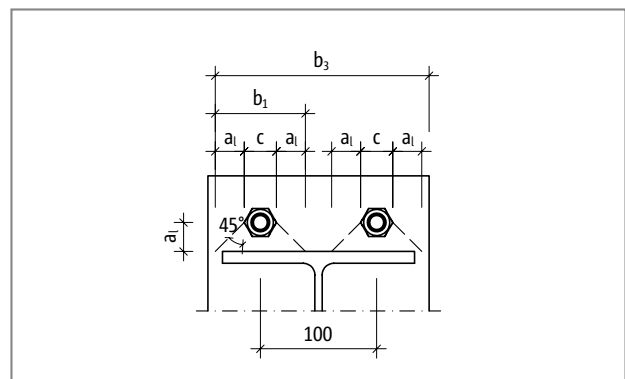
Plaque frontale saillante T type S : calcul des entrées géométriques ; vue globale
